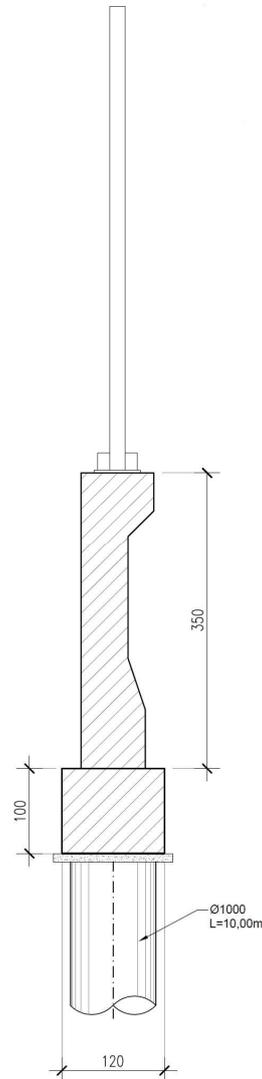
Muro in c.a. su fondazioni profonde – Sezione
